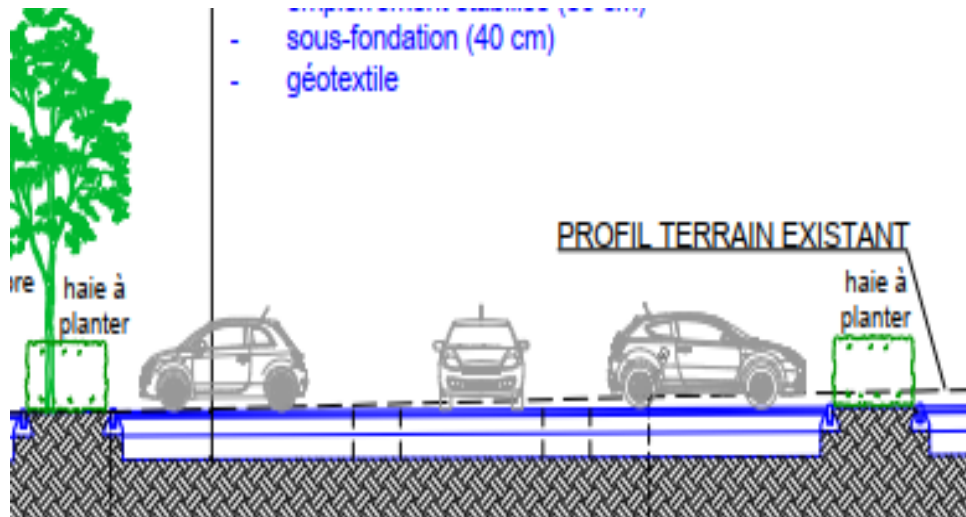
Composition de la fondation du parking projeté (source : 6nergyPark, 2019)
